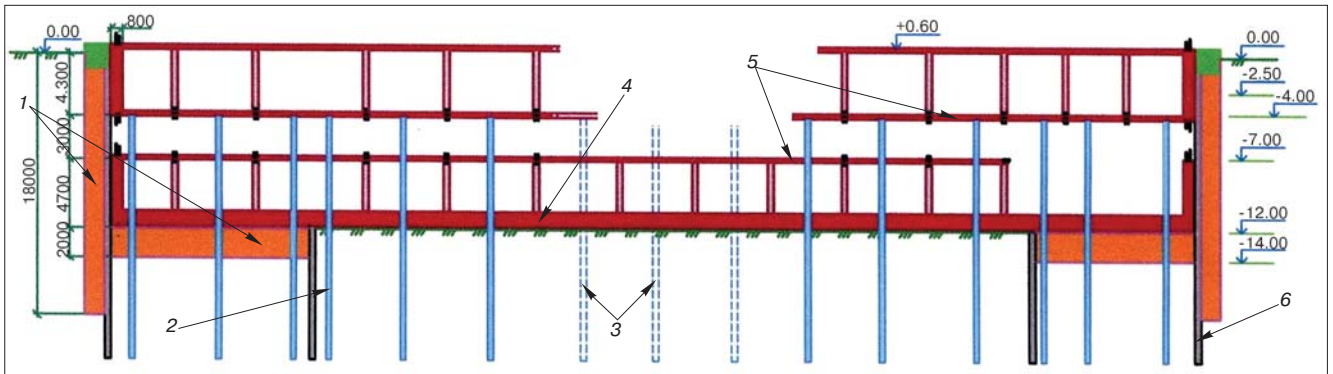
Конструктивная схема разработки подземного пространства: 1 – вертикальная и горизонтальные грунтоцементные диафрагмы; 2 – временные буронабивные сваи; 3 – постоянные буронабивные сваи; 4 – железобетонная плита днища; 5 – железобетонные перекрытия; 6 – шпунтовое ограждение
